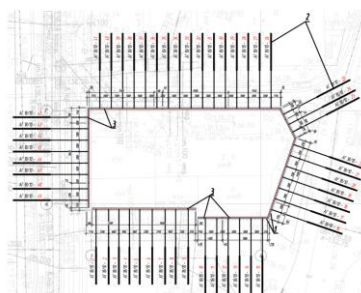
Схема размещения грунтовых анкеров ЭРТ ограждения котлована: 1 - буронабивные сваи ЭРТ; 2 - грунтовые анкера ЭРТ первого уровня; 3 - монолитный железобетонный обвязочный пояс.
